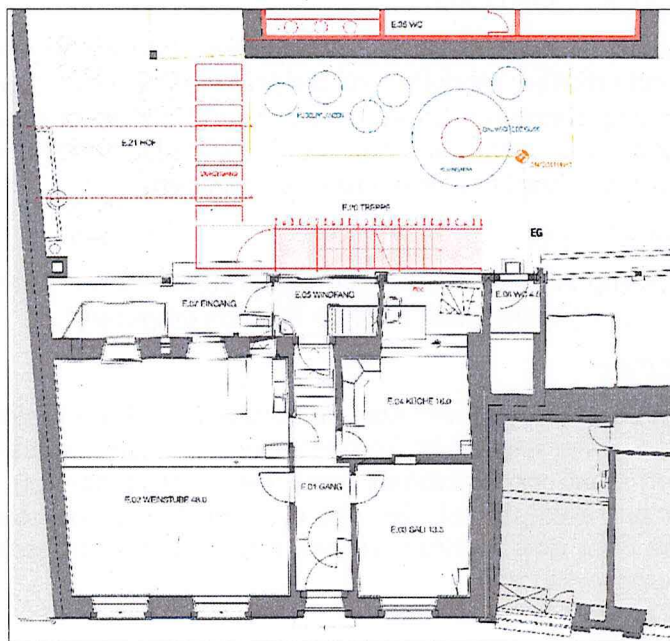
Grundriss Hotelgebäude mit Übergang zu Remise, Erdgeschoss
